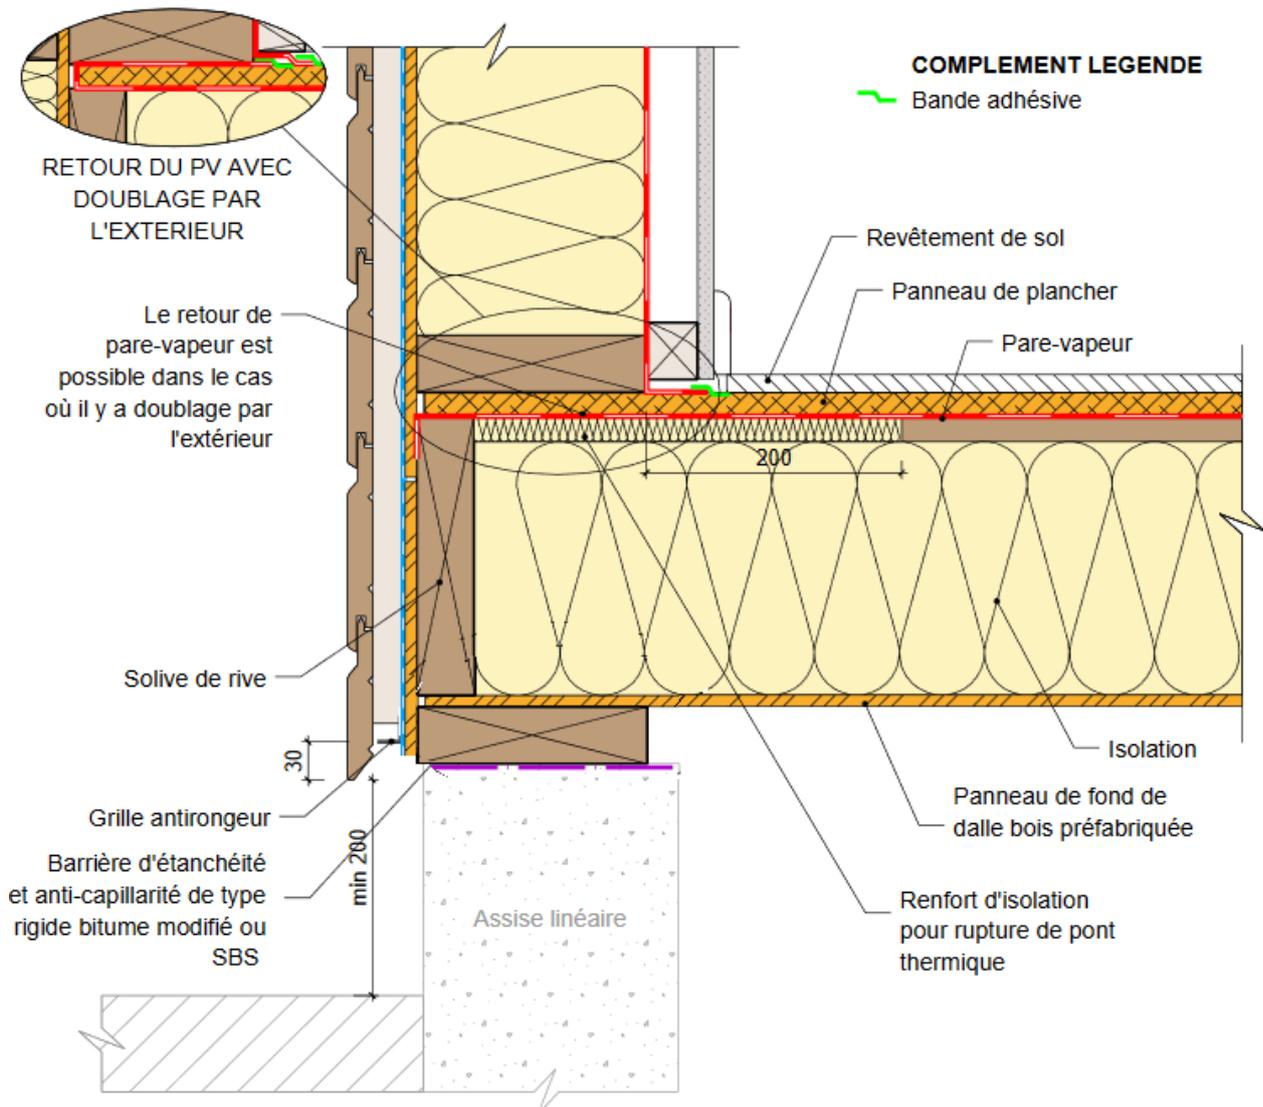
Liaison plancher bas sur vide sanitaire avec un mur extérieur
